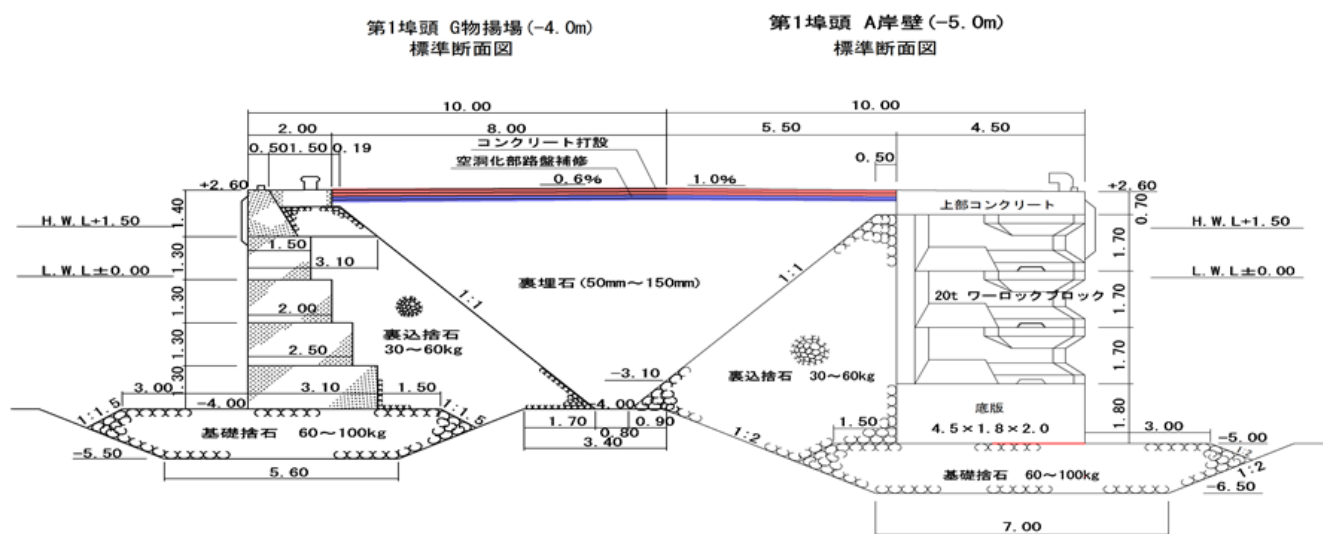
No.27 大洗港区\_第1埠頭 G 物揚場 (-4.0m) (水産ふ頭地区) の断面図 (復旧後)
